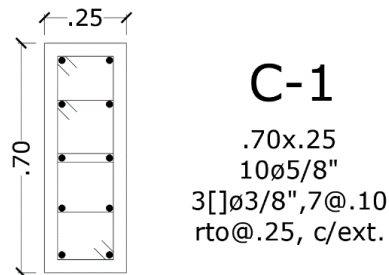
Refuerzo longitudinal y transversal de la columna.
